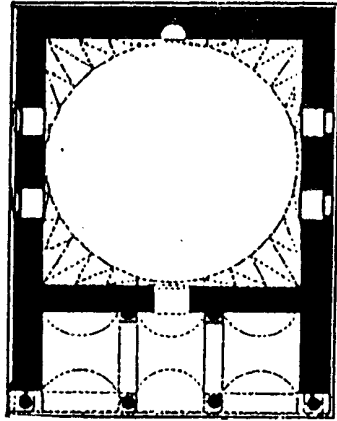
مسقط أفقي لمسجد قاسم في ادرنه (عن : Kuran)
